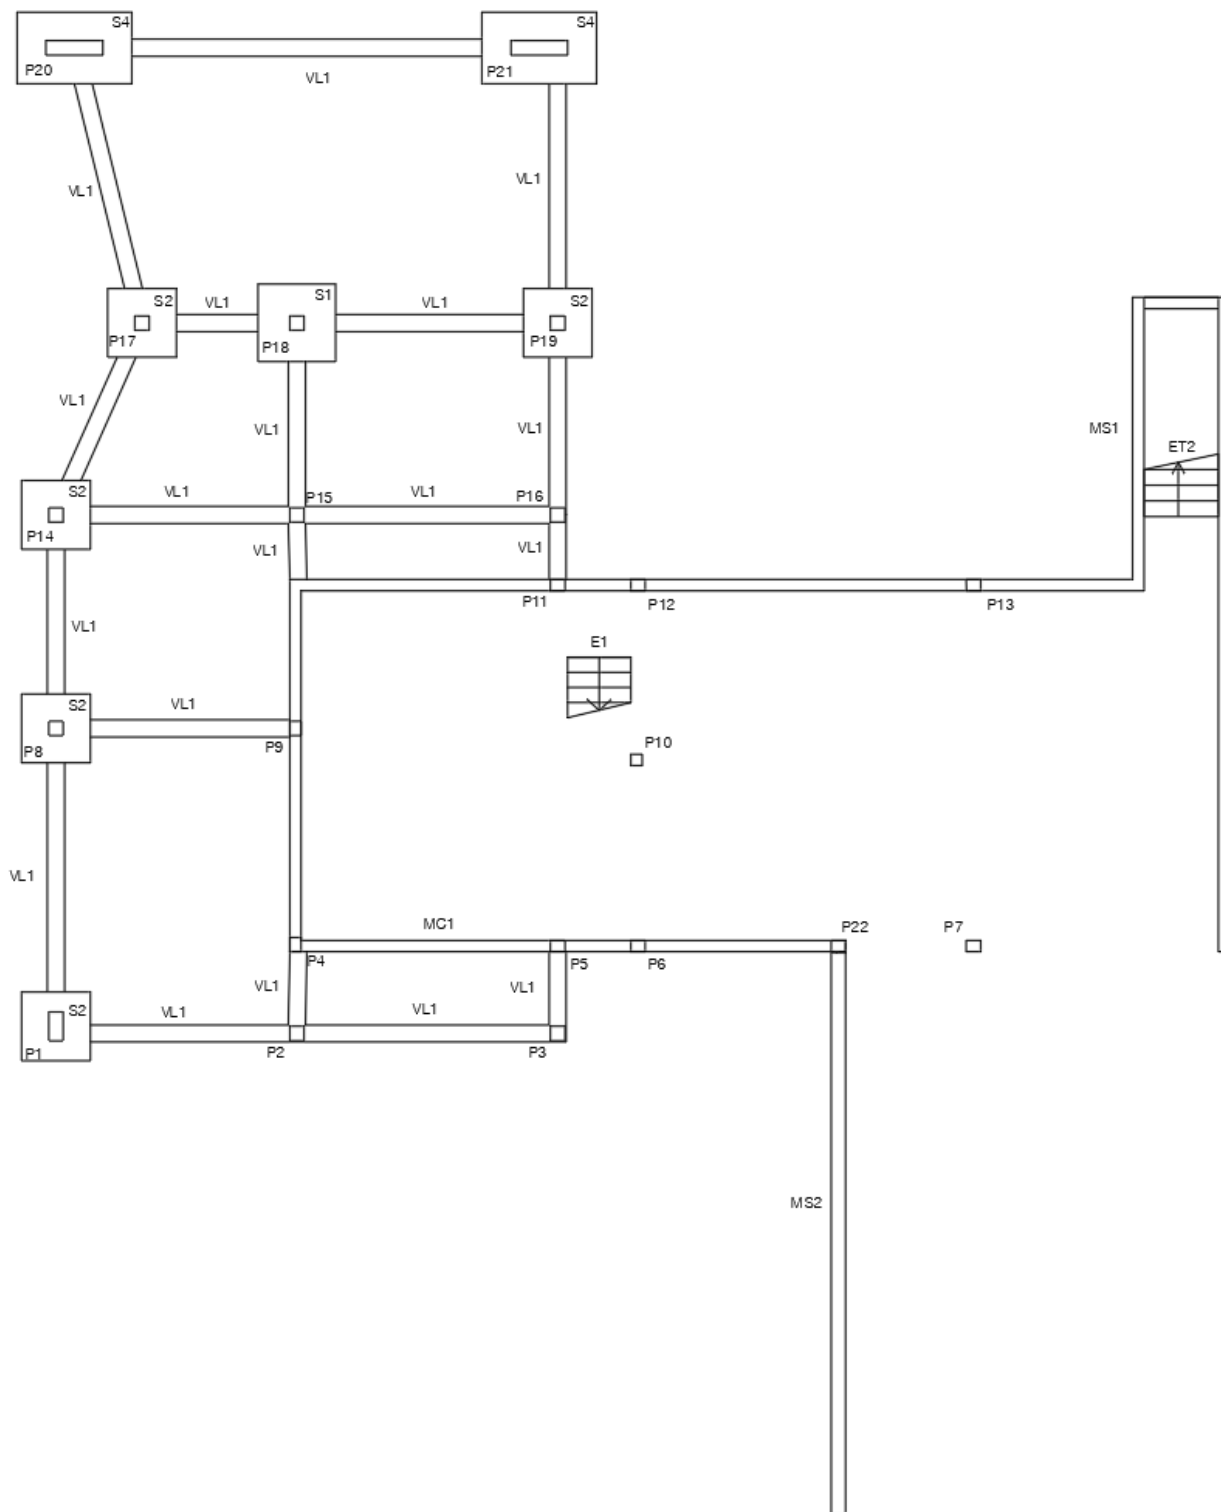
Esquema estrutural da fundação – nível 2 (Projeto de estruturas).
